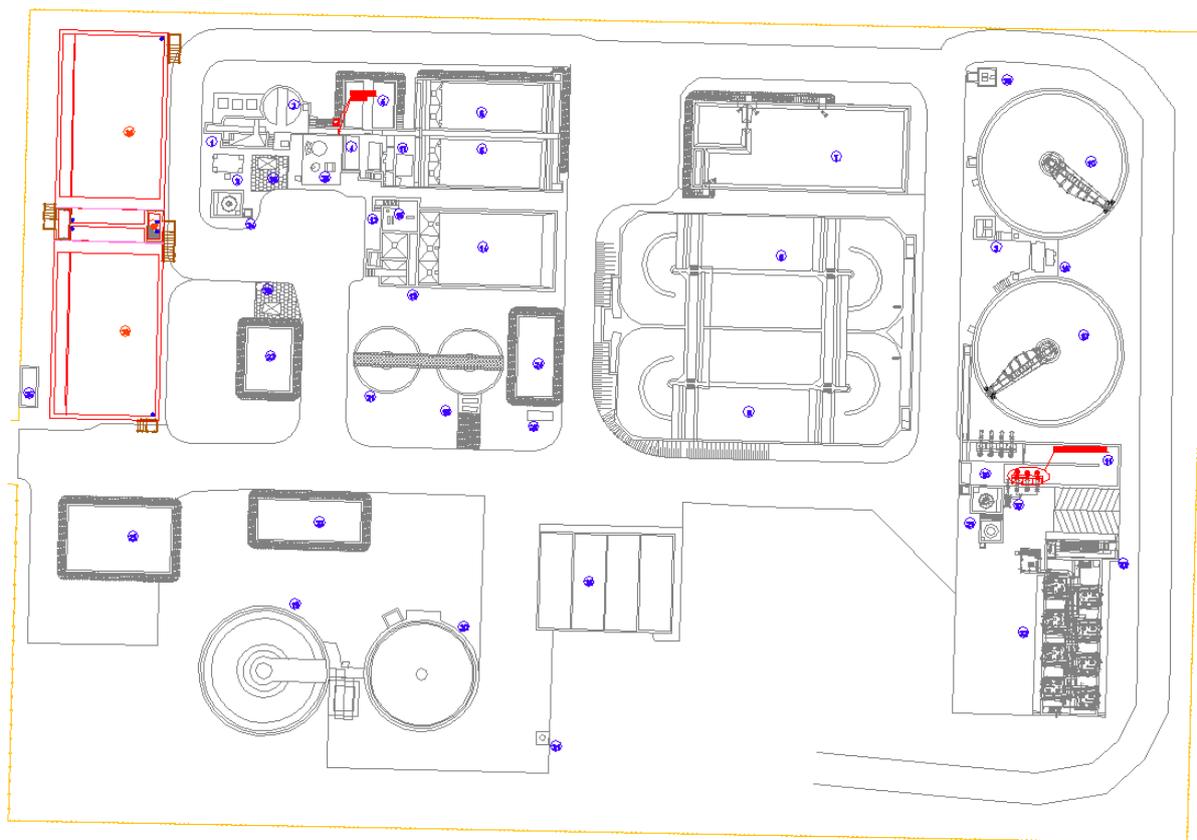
Planimetria impianto di progetto (in ROSSO le opere di adeguamento previste)
